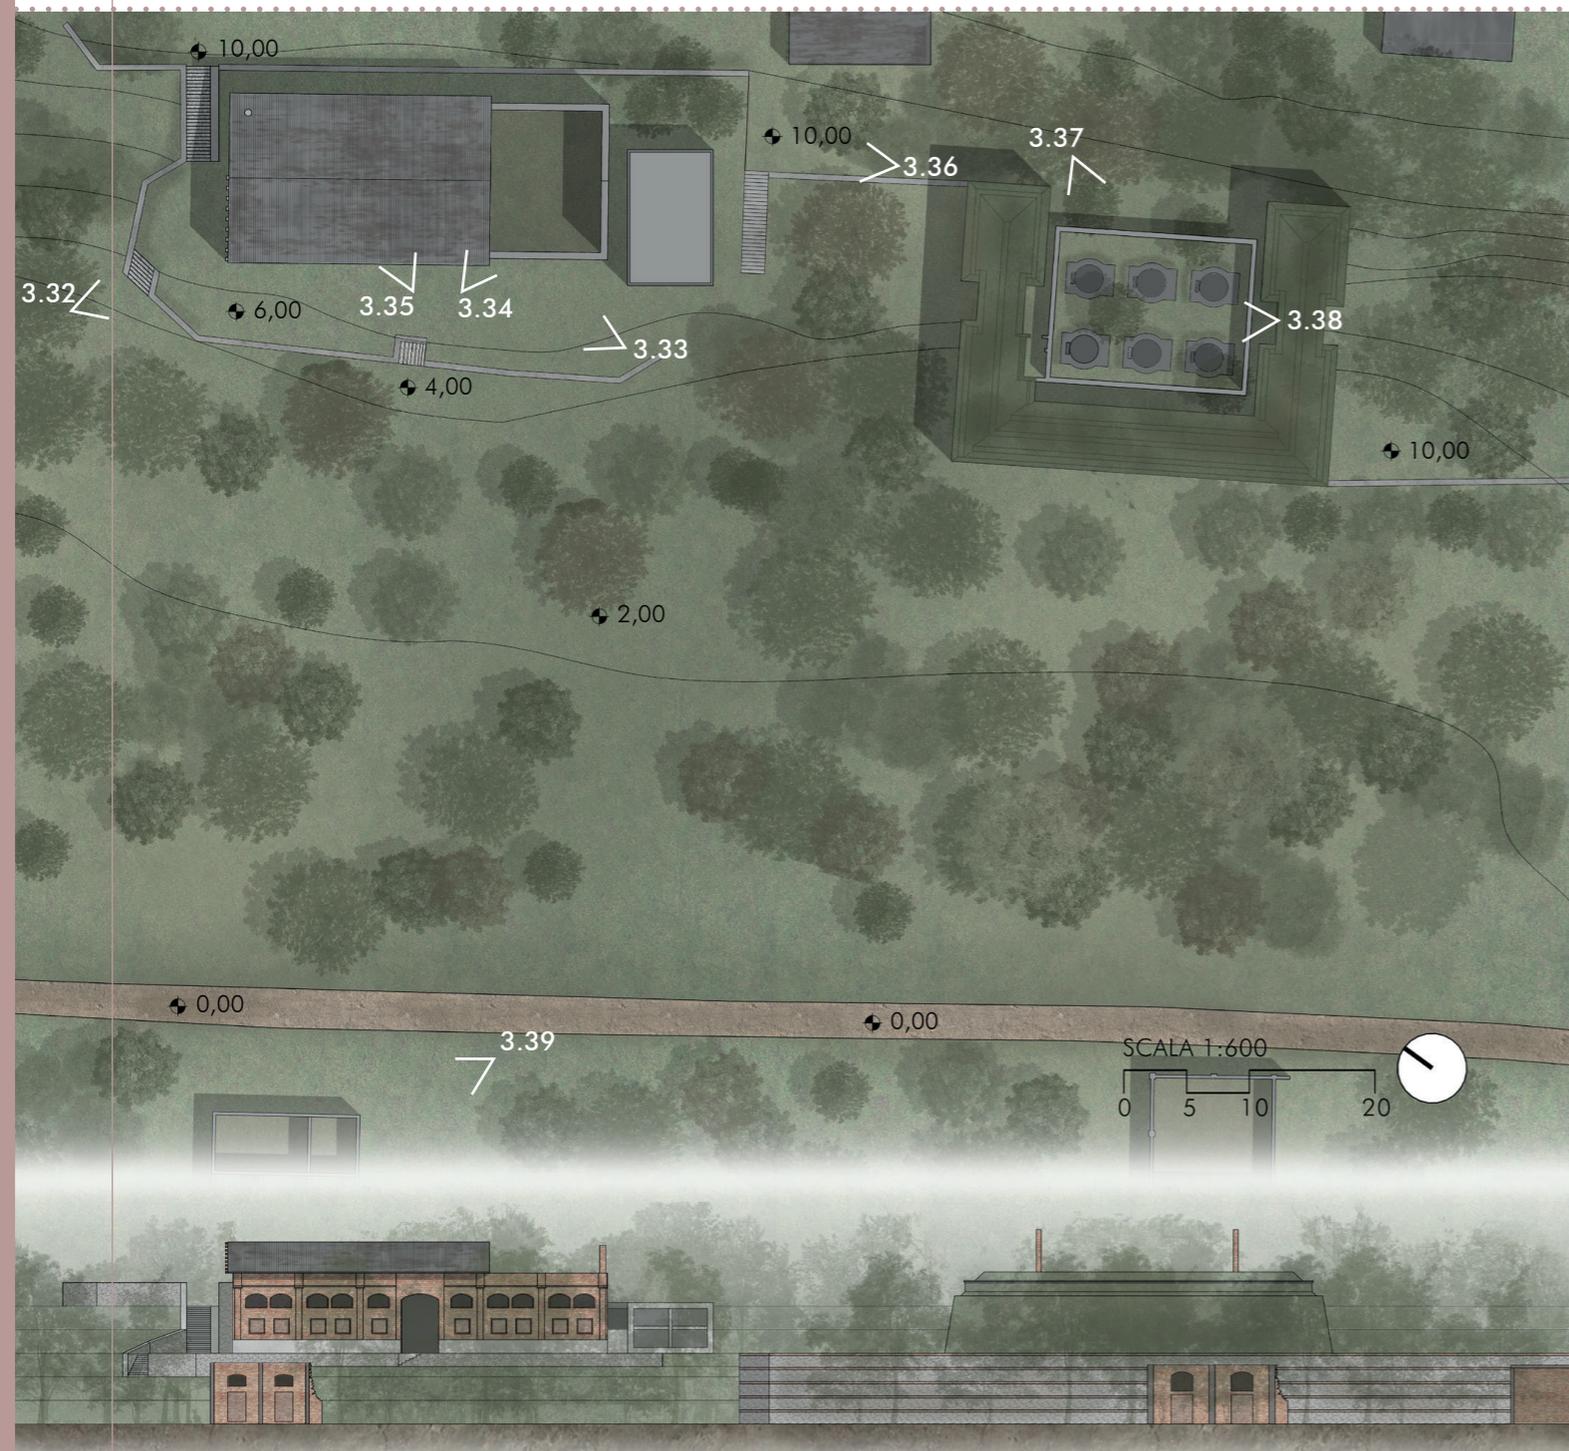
Planimetria e prospetto principale del terzo polo, stato di fatto, elaborazione dalle autrici
